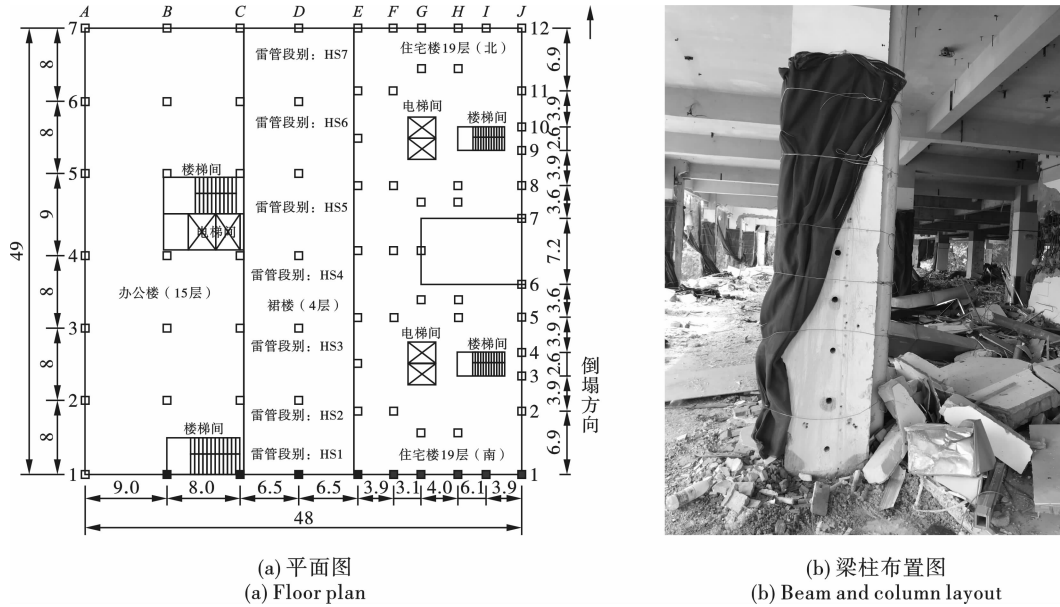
待拆楼房结构平面图及梁布置图(单位:m)
